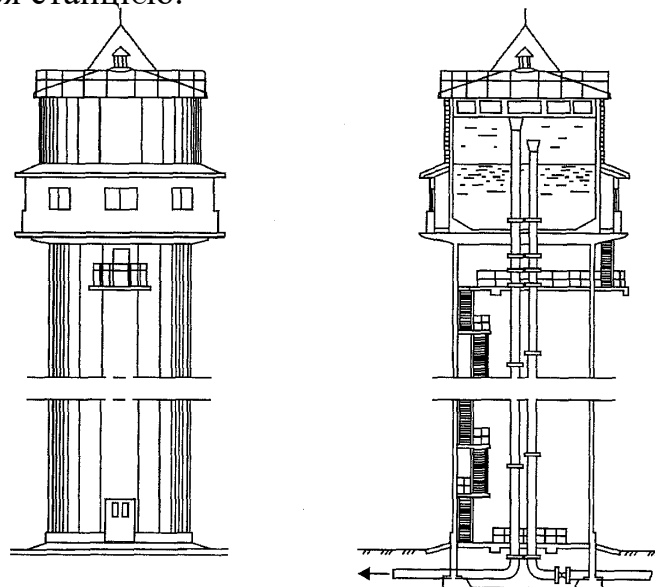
Водонапірна залізобетонна башта з залізобетонним баком
